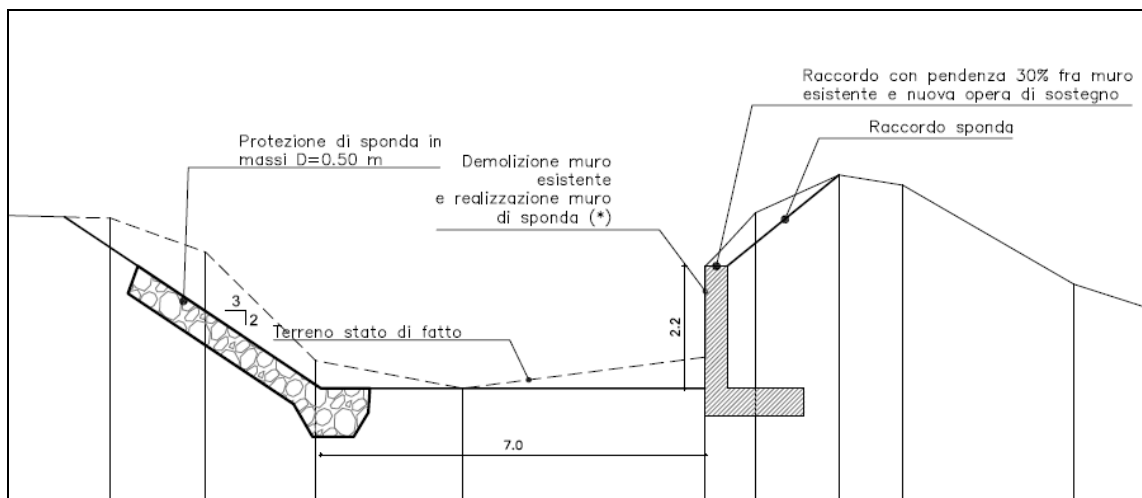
Sistemazione idraulica dell'alveo – primo tratto
